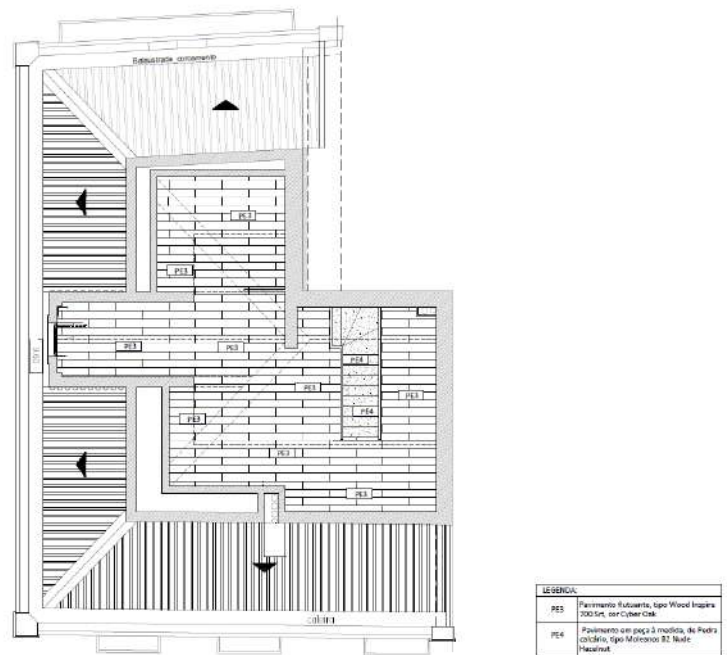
Planta de Pavimentos - Piso das Águas-Furtadas
